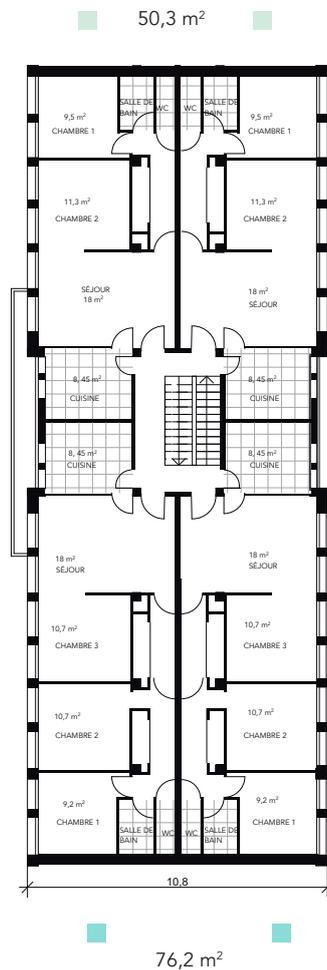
Plans Étage courant, immeuble du bâtiment I ©VA
